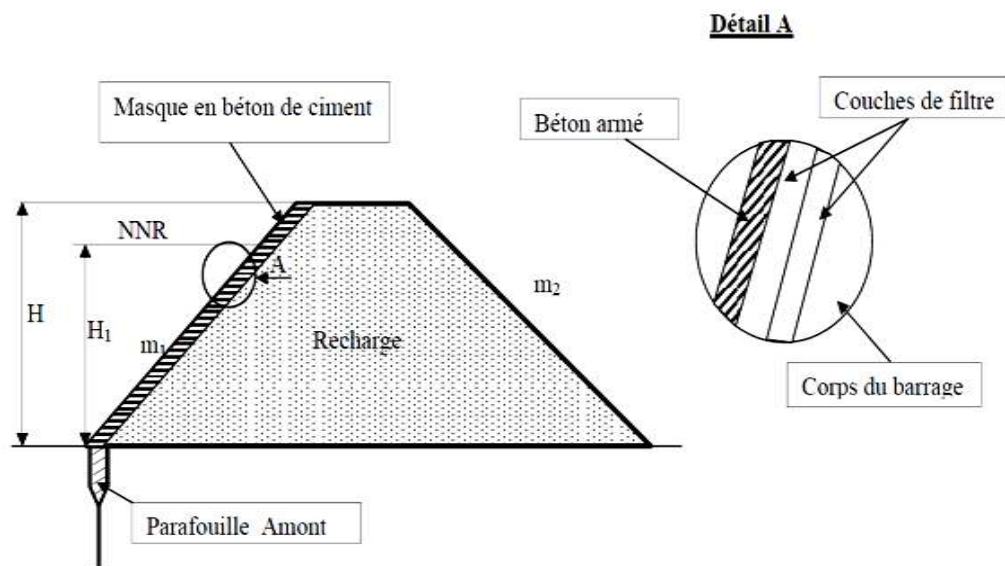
Masque en béton de ciment (Messaid, 2009)
